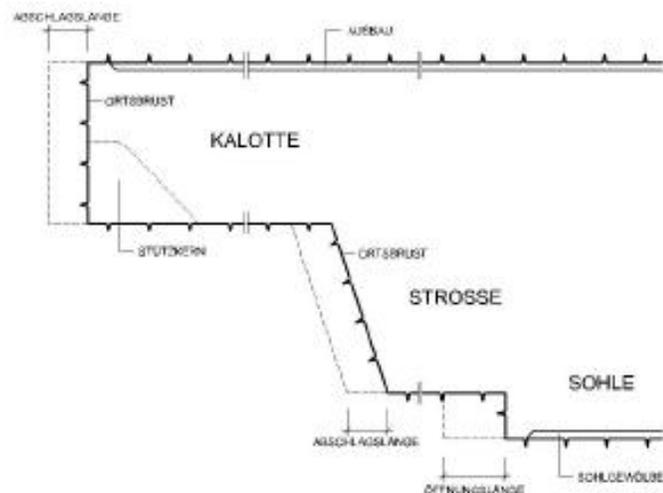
Tunnelbautechnische Begriffe – Längsschnitt<sup>14</sup>
